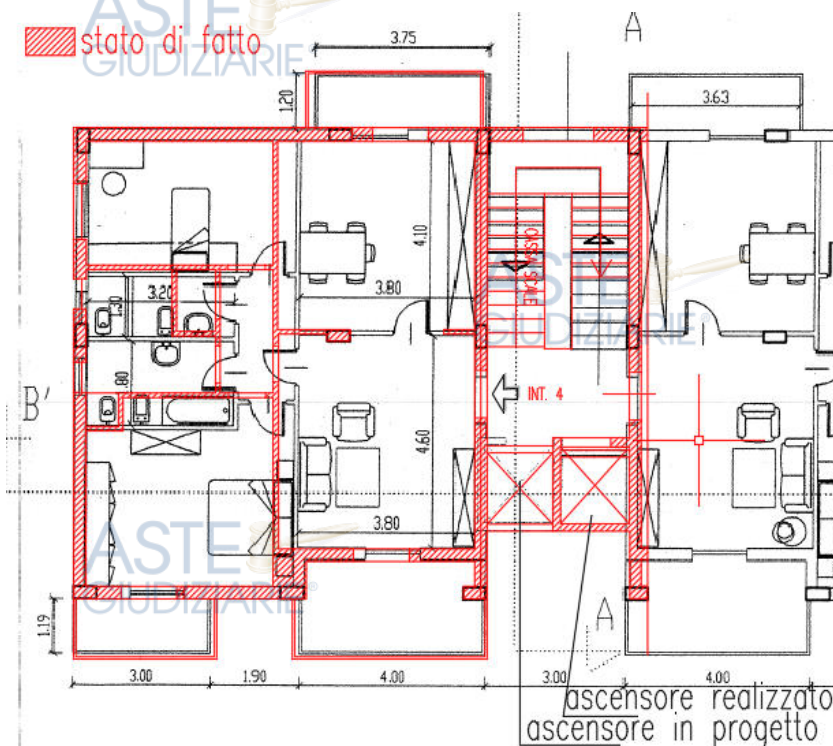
Sovrapposizione planimetria dello stato dei luoghi e planimetria di progetto allegata alla Concessione.
